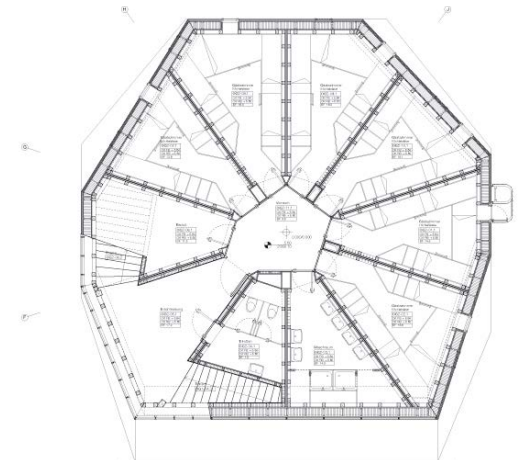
Pianta piano secondo del Monte Rosa Hütte
